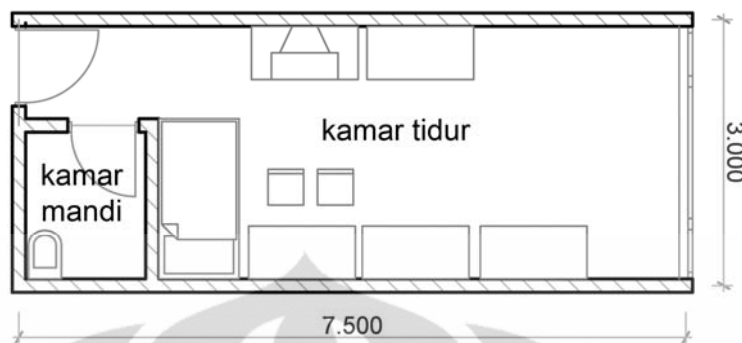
6: Denah Lantai 3 Pondok Kukusan Pria
